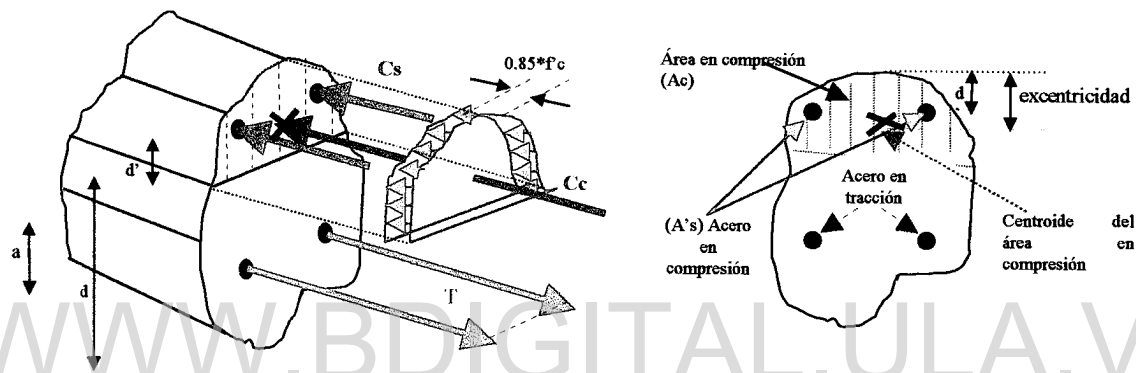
Fuerzas de compresión y tracción en elementos de concreto armado
